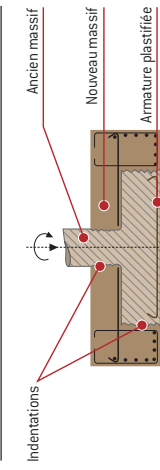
Fondations : renforcement avec surépaisseur de la semelle (coupe transversale)
